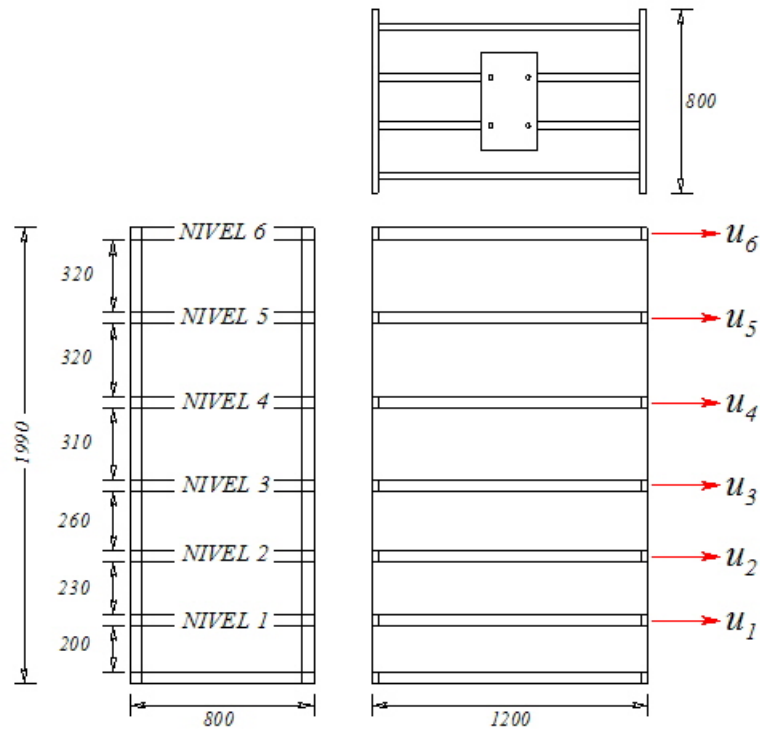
Vista en planta y elevaciones principales de la estructura. Las dimensiones están en milímetros. Se indican asimismo los grados de libertad utilizados para el análisis posterior de la estructura.
